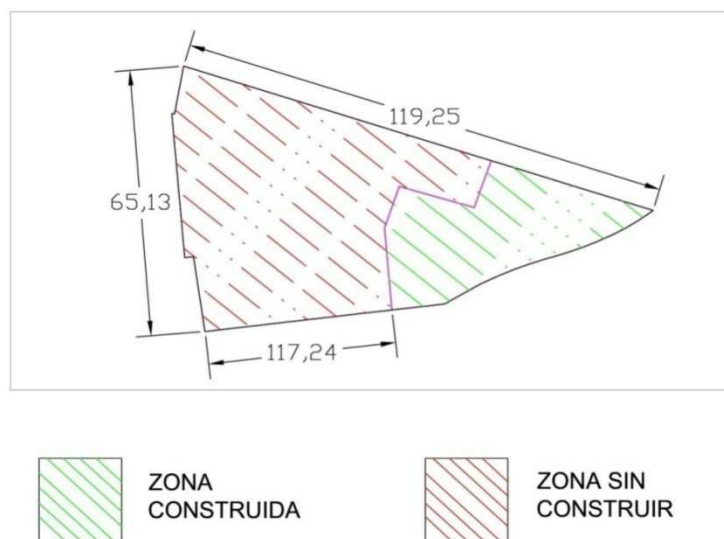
Distribución en planta de la parcela antes del proyecto.
